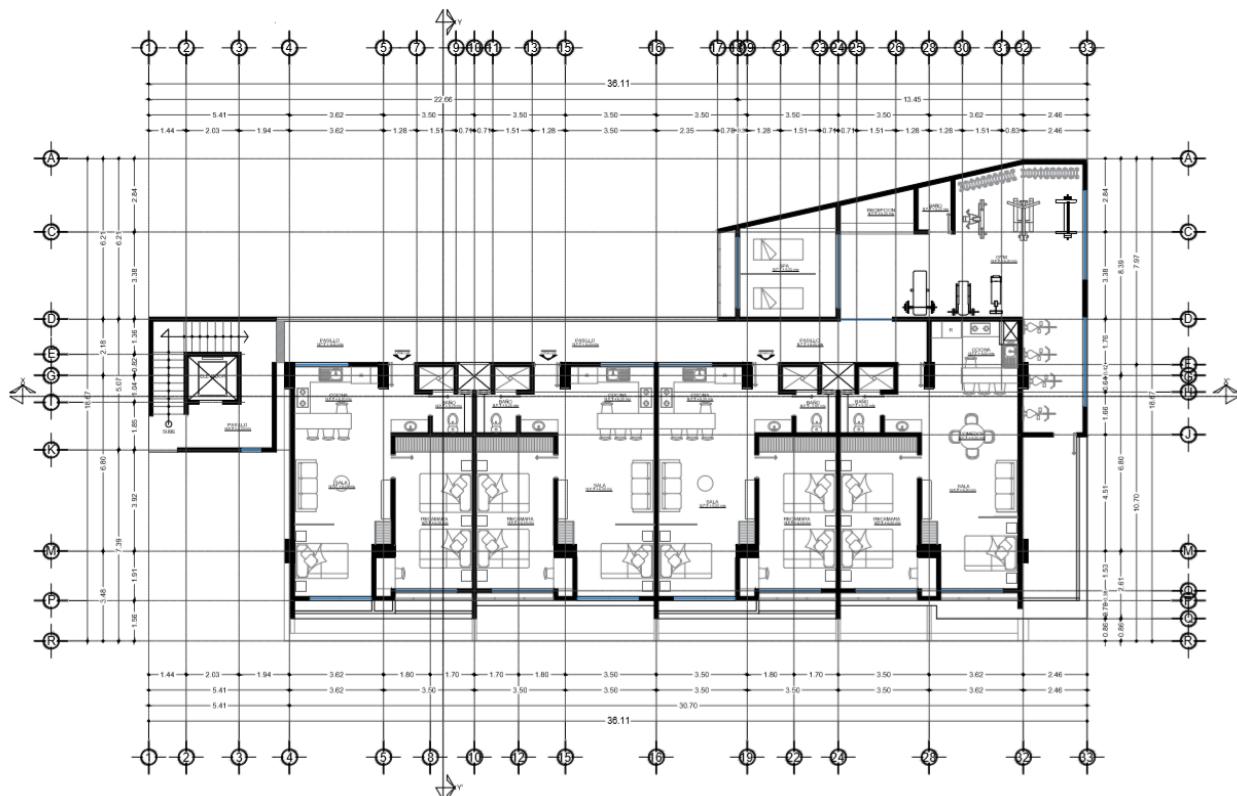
Planta arquitectónica del segundo nivel del Edificio B.
